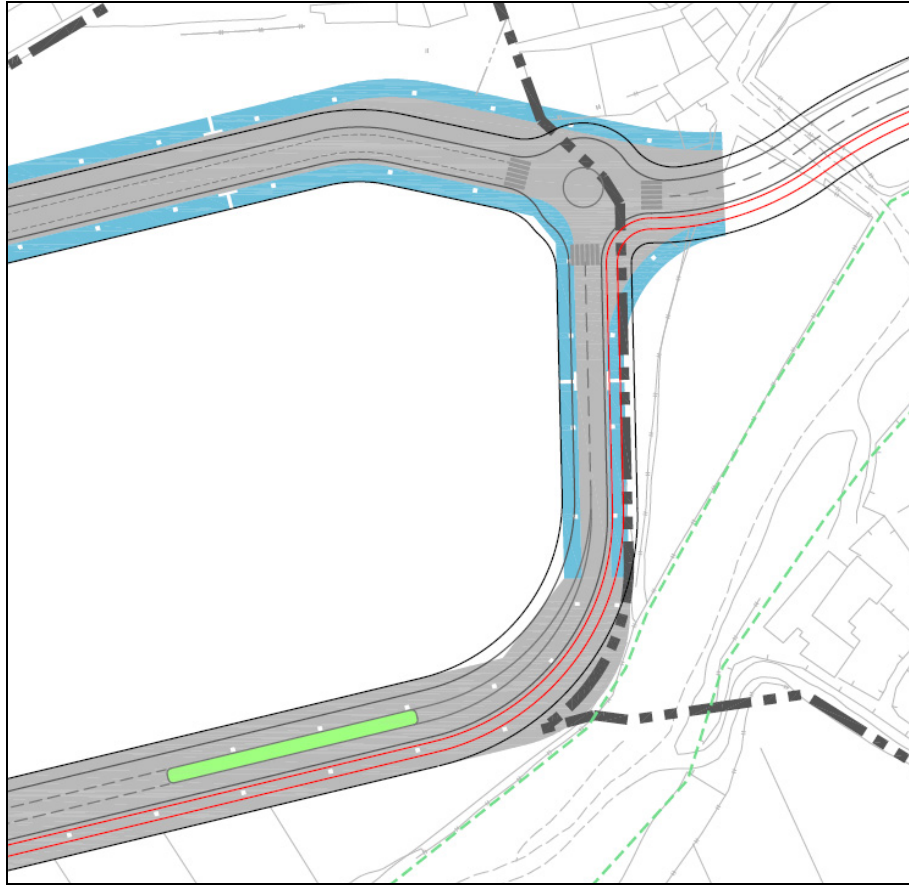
Intersección entre la vía perimetral y la vía de conexión Este. A
